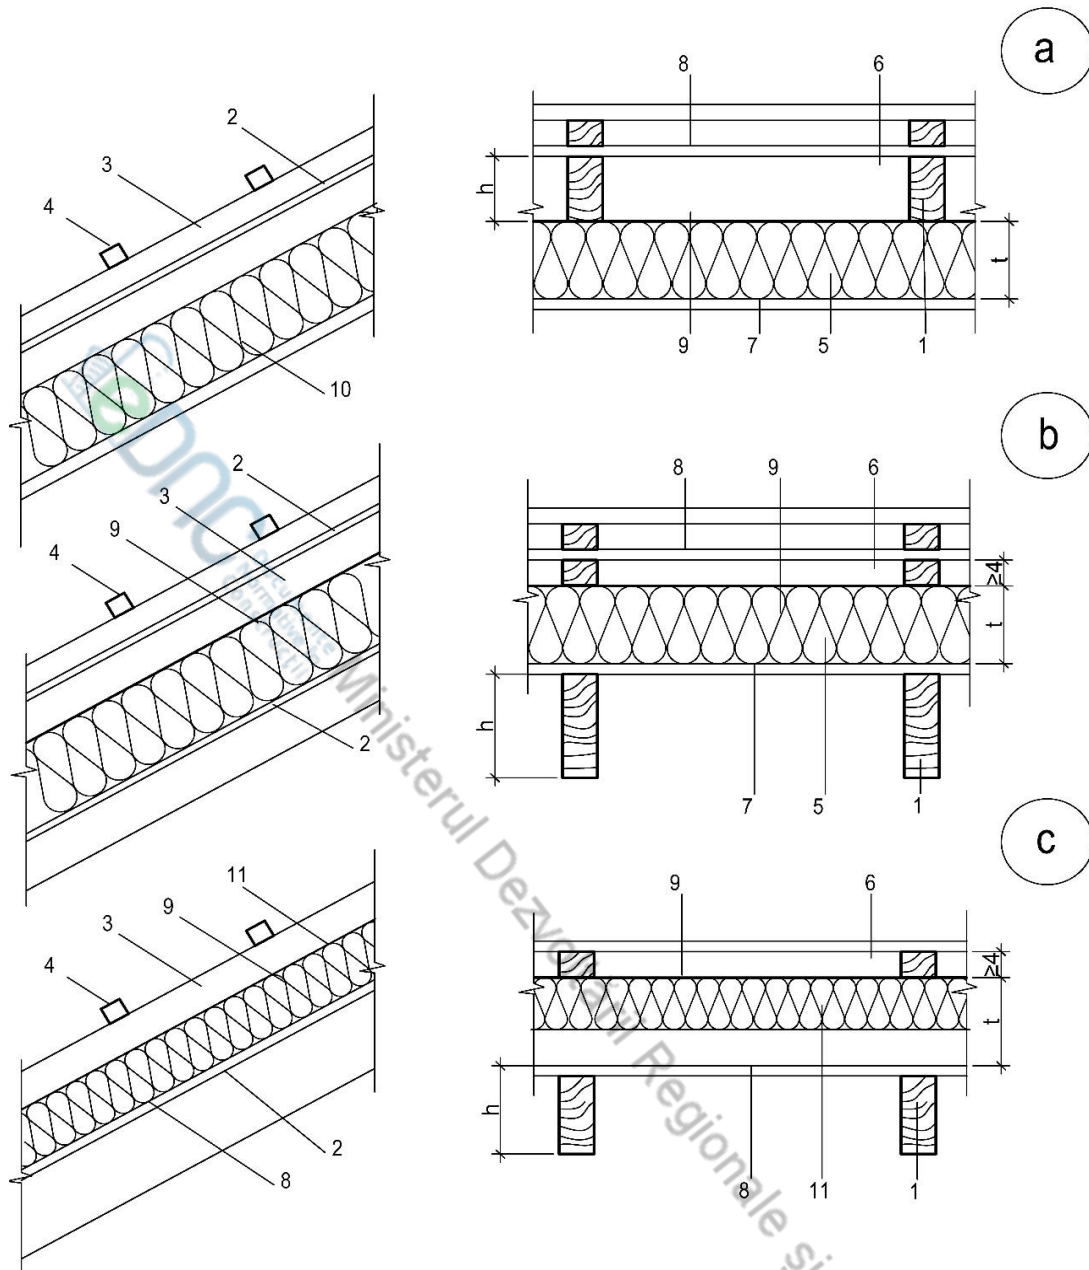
Расположение теплоизоляционного слоя под или над стропилами
